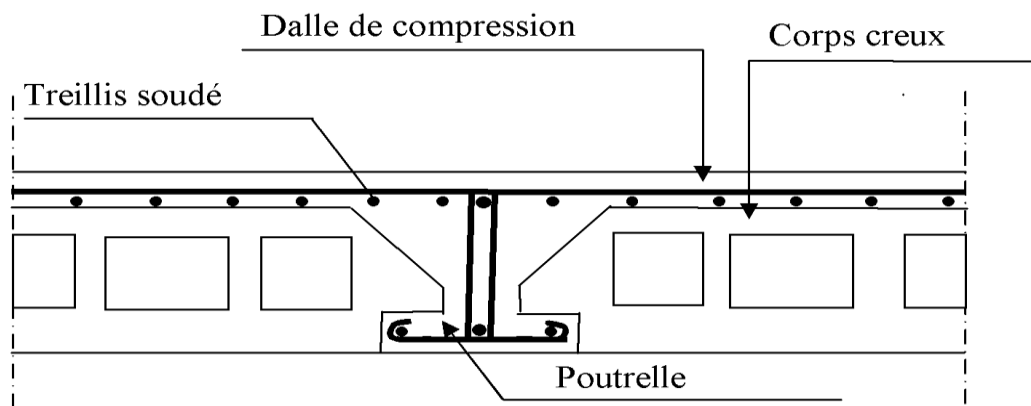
Coupe transversale d'un plancher à corps creux
